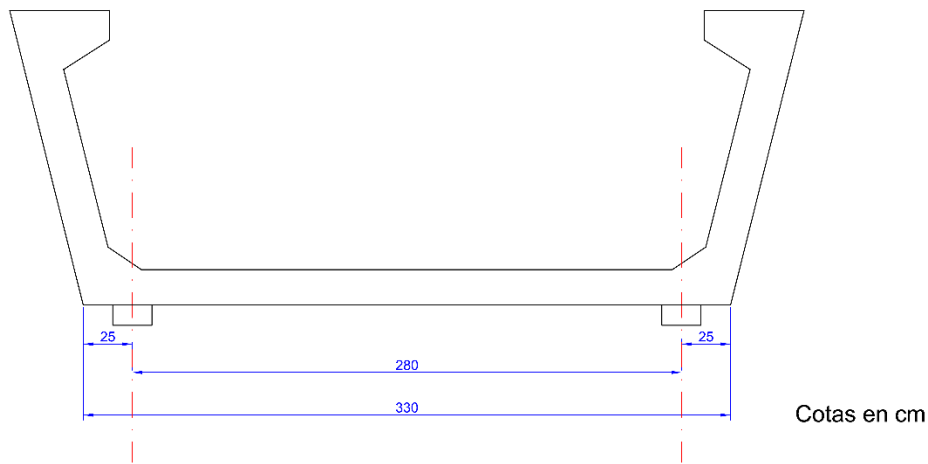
Croquis detalle de la ubicación de los apoyos
